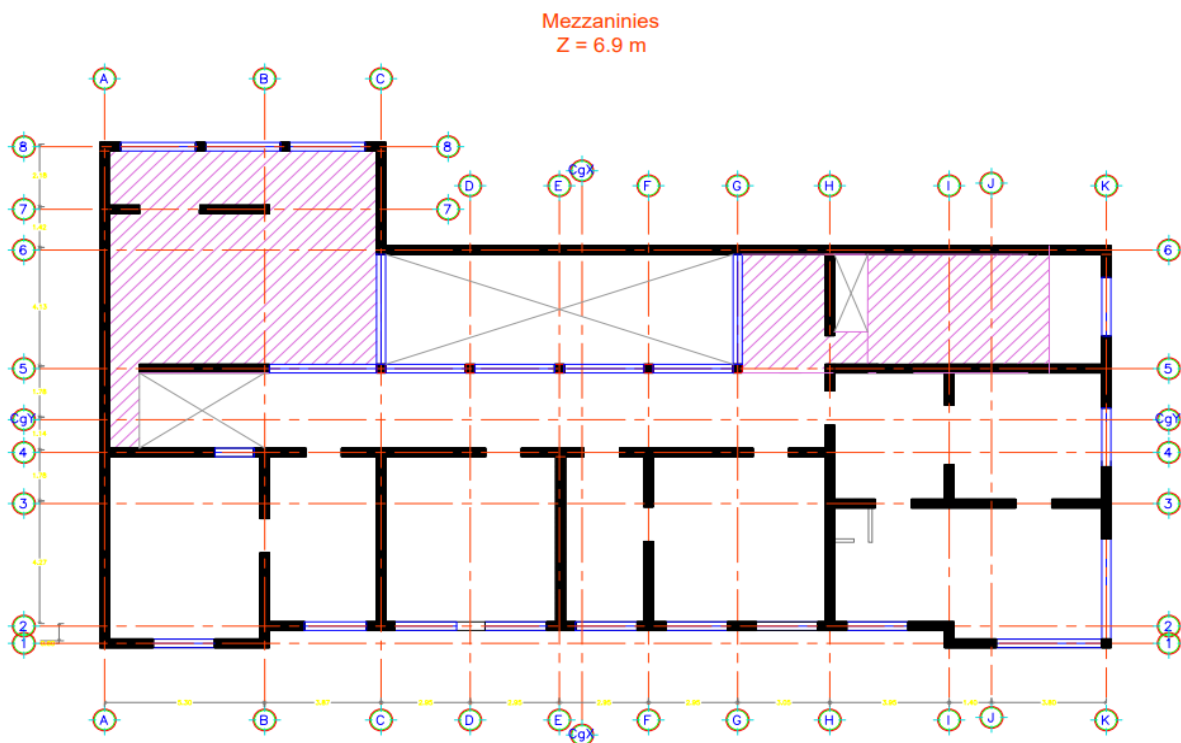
Edificio Nacional vista en planta piso 2 con mezzaninies
